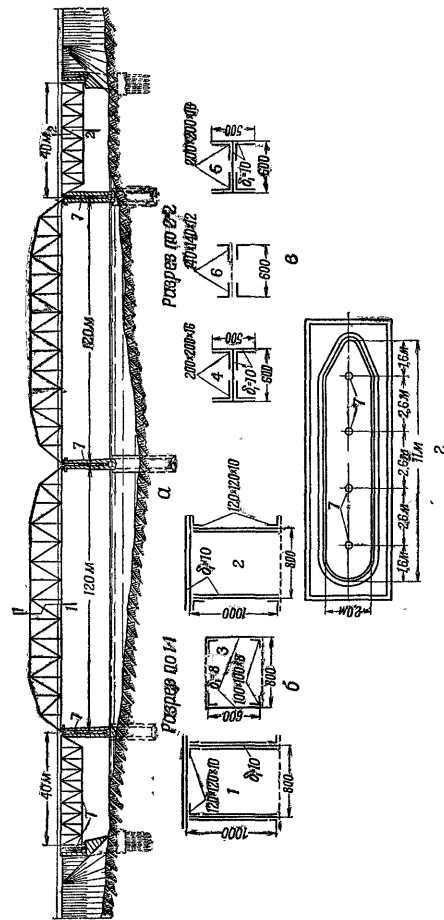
Схема металлического моста, подлежащего подрыванию: а — продольный разрез; б — сечения элементов ферм в средних пролетах; в — сечения элементов ферм в крайних пролетах; 1 и 4 — нижние пояса ферм; 2 и 5 — верхние пояса; 3 и 6 — раскосы; 7 — зарядные трубы
